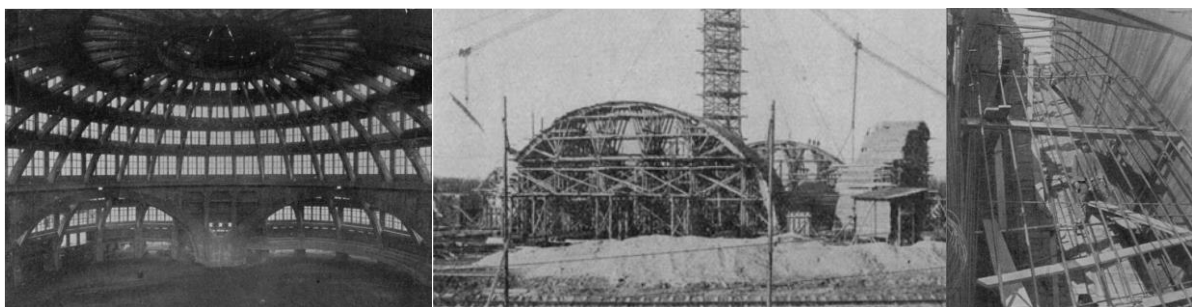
Jahrhunderthalle in Breslau: Innenansicht der Rippenkuppel aus Stahlbeton 1911–1913 [20] (links), Lehrgerüst und Schalung der Hauptbögen [20] (Mitte), Schalungsinnenansicht und Eisenlagen der Hauptbögen [20] (rechts)
